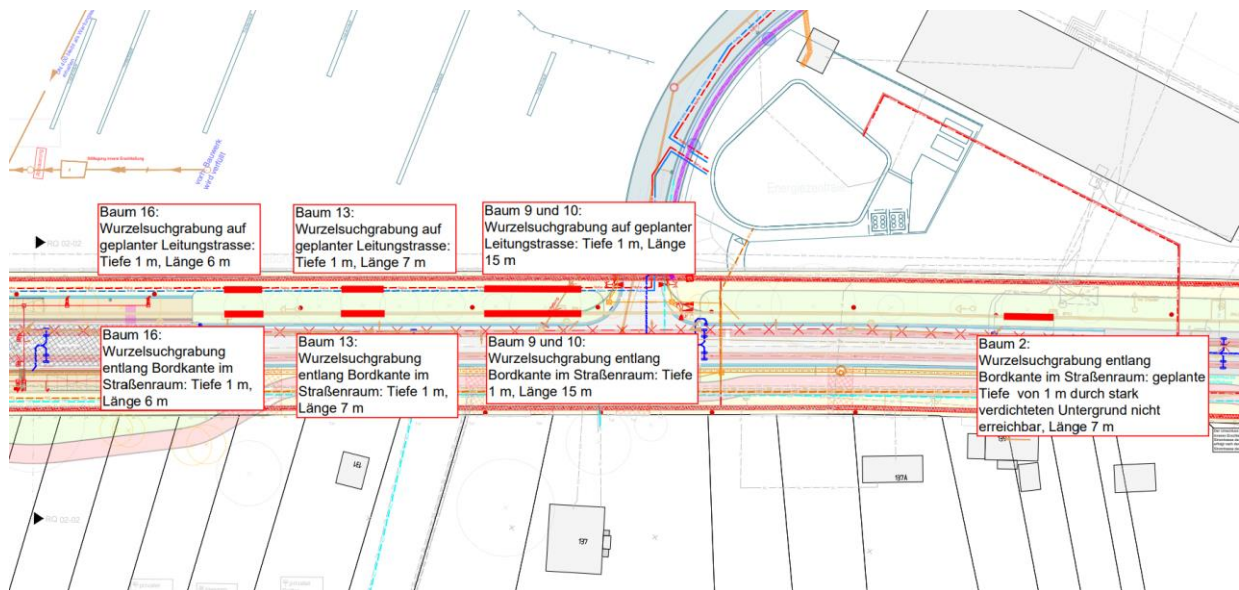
Lage der Suchgräben im südlichen Straßenabschnitt, rot markiert; Ausschnitt aus dem koordinierten Gesamtleitungstrassenplan Ludwigshöhstraße; Quelle: Schüßler-Plan Ingenieurgesellschaft mbH
